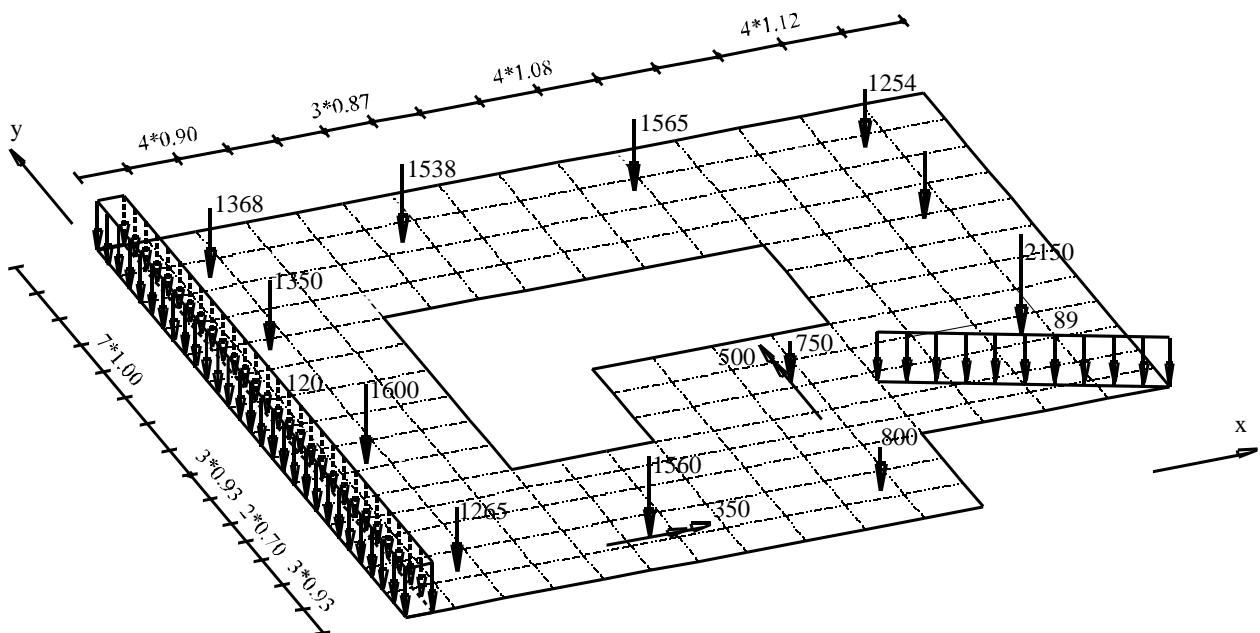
Grundriss der Platte [m] und Lasten
